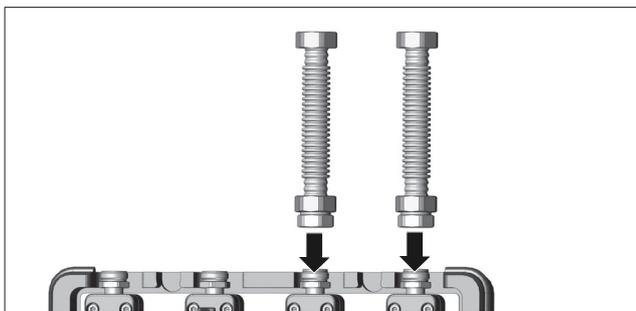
Vissage du tube de raccordement (raccordement par le haut)
